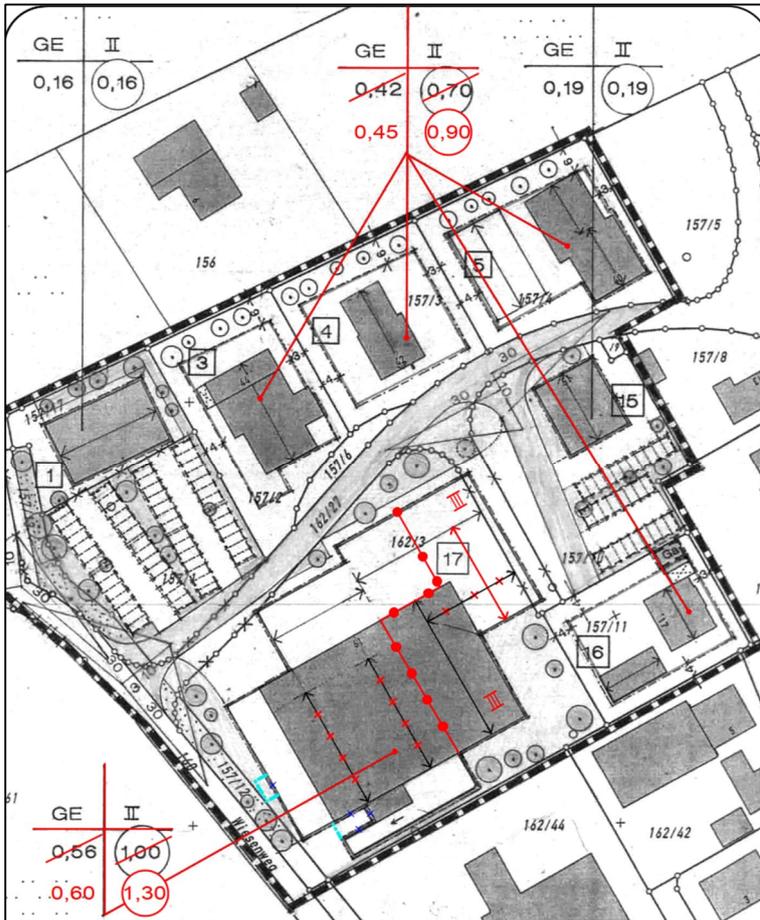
Planzeichnung des Bebauungsplans "Schratenbachstraße II", 12. Änderung /18/
